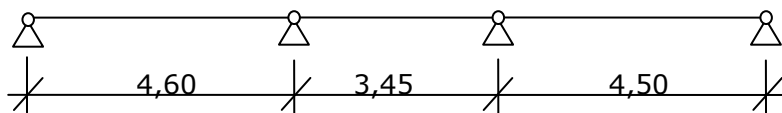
Statisches System der Decke über EG als Brettsperrholzdecke
